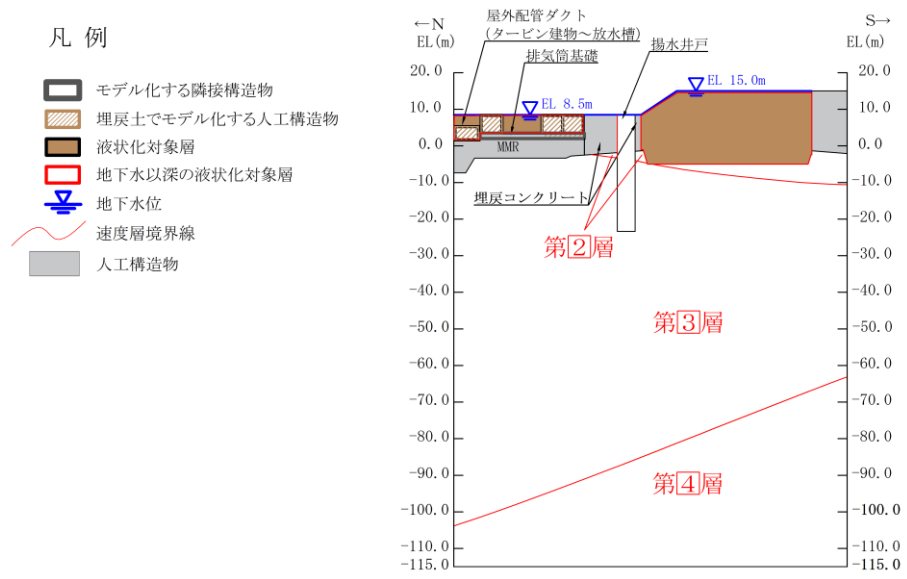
評価対象断面図 (B-B 断面 (南北方向))
